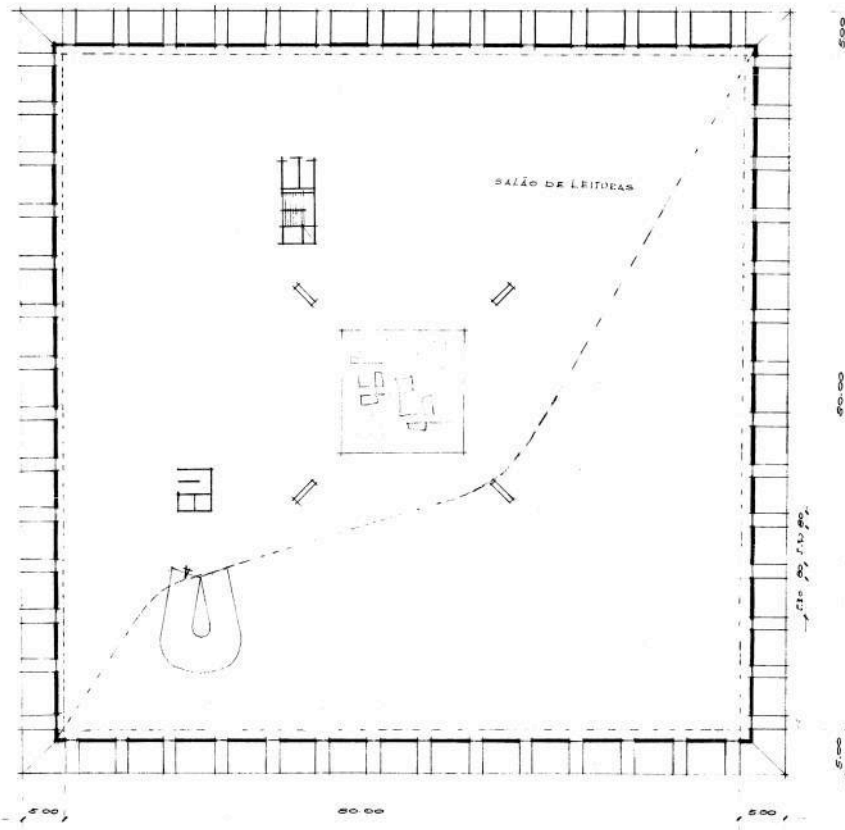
BNB, planta baixa – térreo, 1969. Fonte: ArqPDF.
